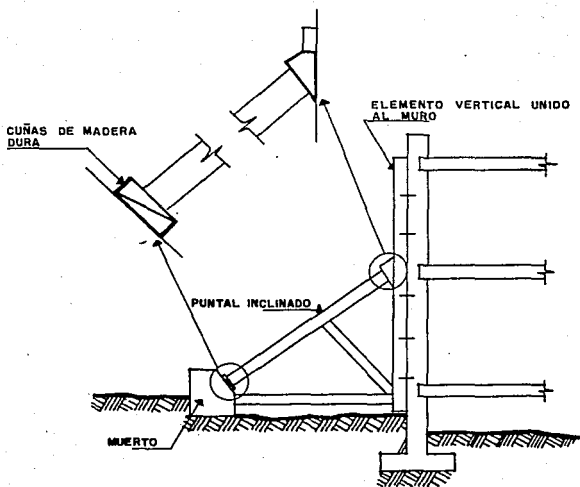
Apuntalamiento exterior (Ref.15)
